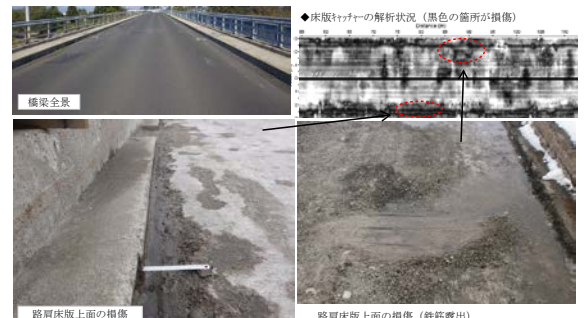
床版キャッチャーの解析画面と路肩の損傷状況
